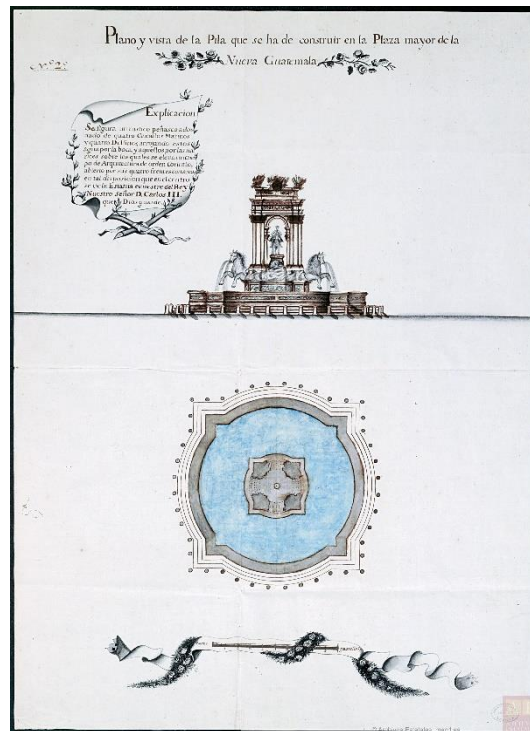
Fachada y planta de la fuente con escultura ecuestre de Carlos III, 1785.<sup>1721</sup>
